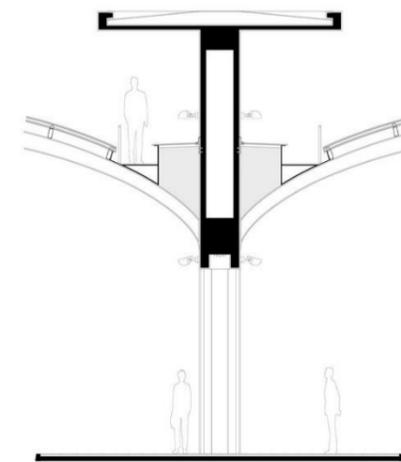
CORTE. FONTE: ARCHDAILY.
